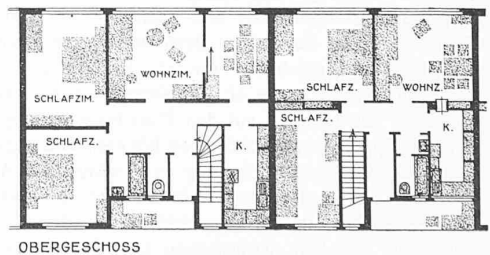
Typ D und E, Zweifamilienhäuser mit vier bzw. drei Zimmern. Wohnraum $4,15 \times 3,75$ bzw. $4,35 \times 3,82$ m. Nordwestfassade und Grundrisse 1 : 300.
